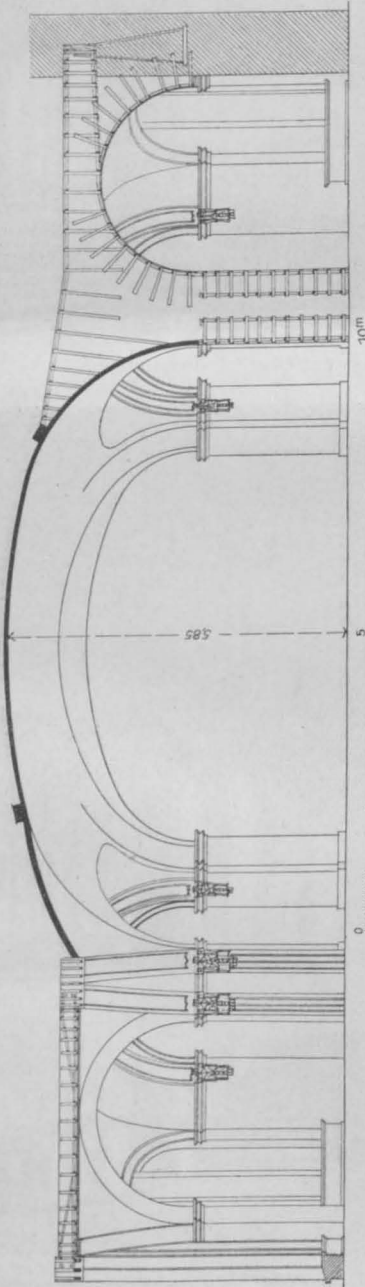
Schnitt durch die Eisenbetonkuppel und ihre Widerlager (links nach der Achse des unten stehenden Grundrisses Abbildung 19, rechts schräg durch Tragkonsole, Stützpfeiler und Gegenkonsole geführt).
